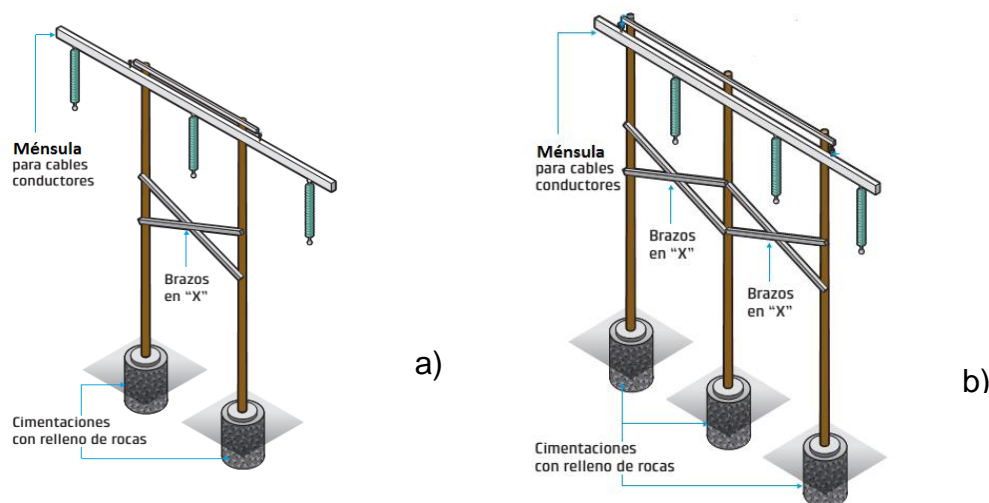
a) Postes de concreto tipo H b) Postes de concreto para Uso de remate y suspensión¹⁷
